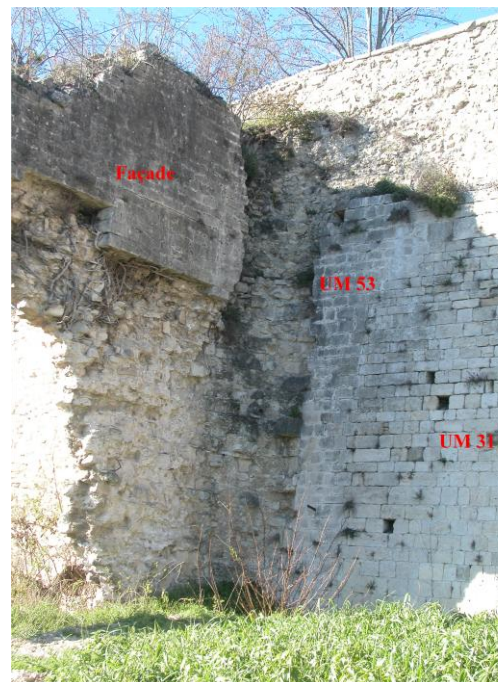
Jonction du mur gouttereau ouest avec le mur de façade (cl. M. Varano).
